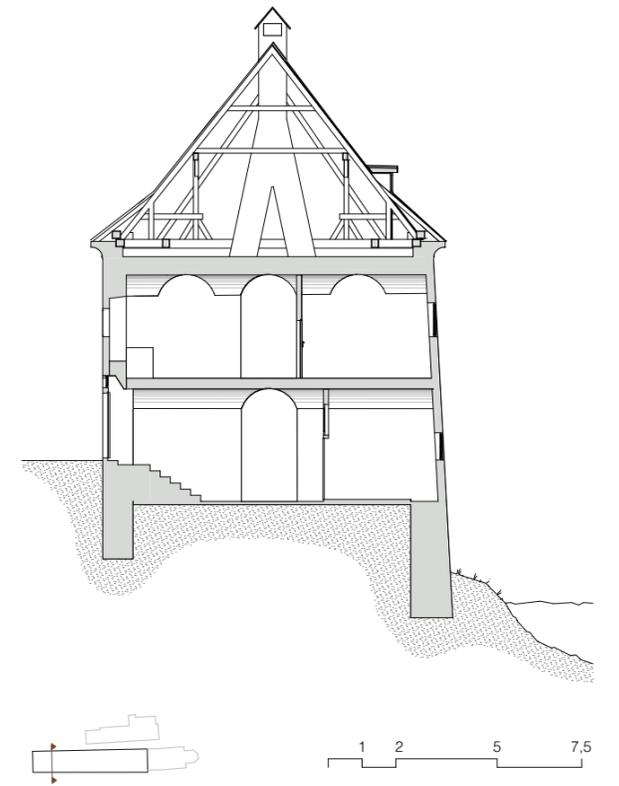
Bestandsplan. Schnitt B-B Spitalstrakt
